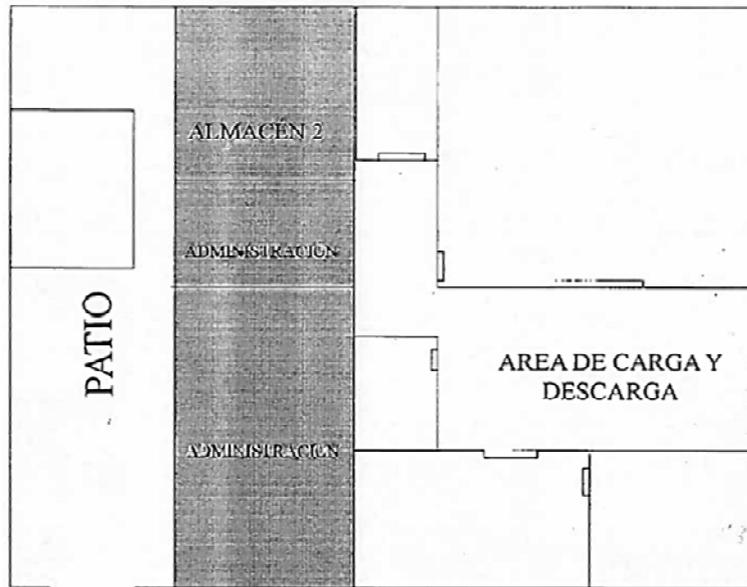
Planta Alta empresa Dulces y Confitados Danny's
